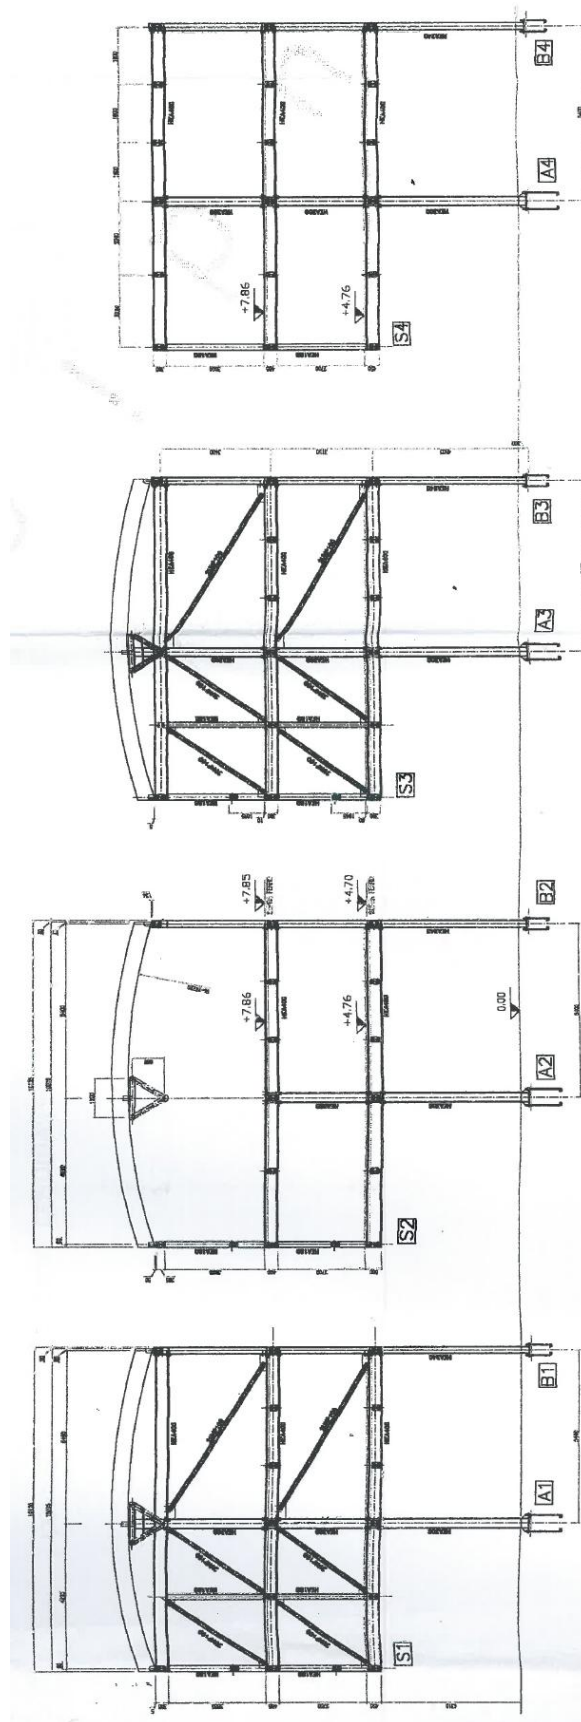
Particolare di A.2003.a.us.c.T13 - Prospetti e sezioni - Sezioni trasversali
